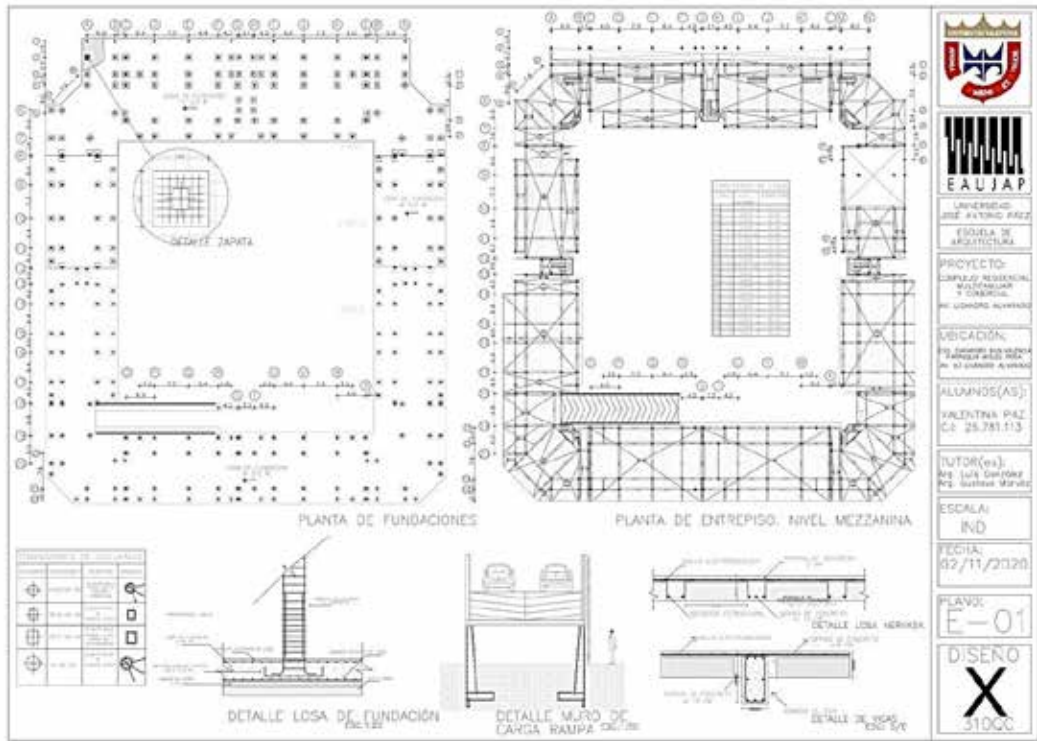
Estructura. Detalles de Losas. Autora (2020).
